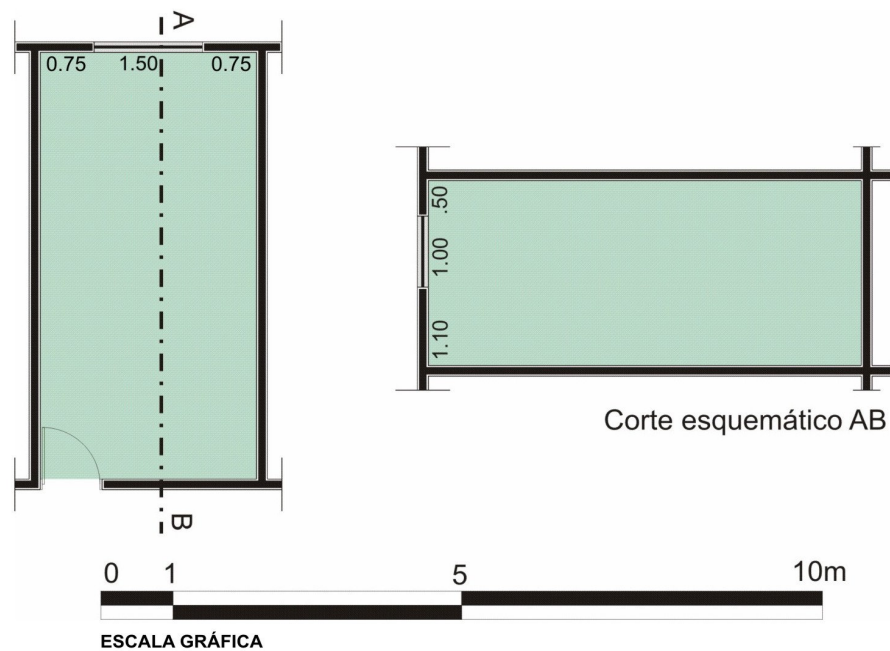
Planta baixa e corte esquemático dos módulos com tipologia de abertura: janela comum.
